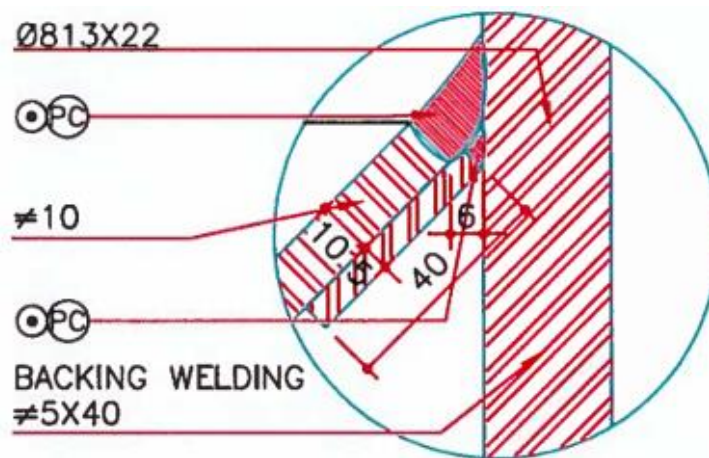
Esquema de soldadura con ubicación de anillo a más de 1m del extremo del pilote
